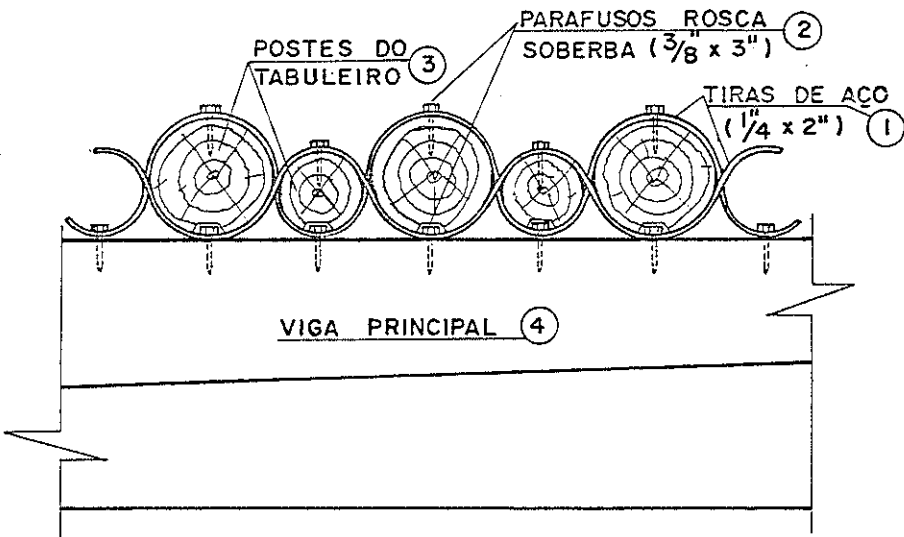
LIGAÇÃO DOS PILARETES NA PONTE
